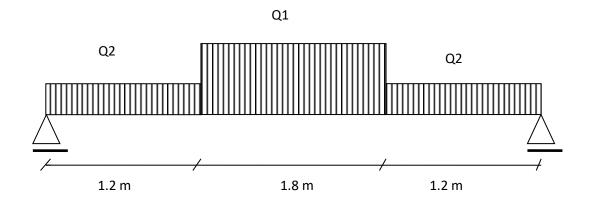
schéma statique d'un escalier a poutre palière escalier
